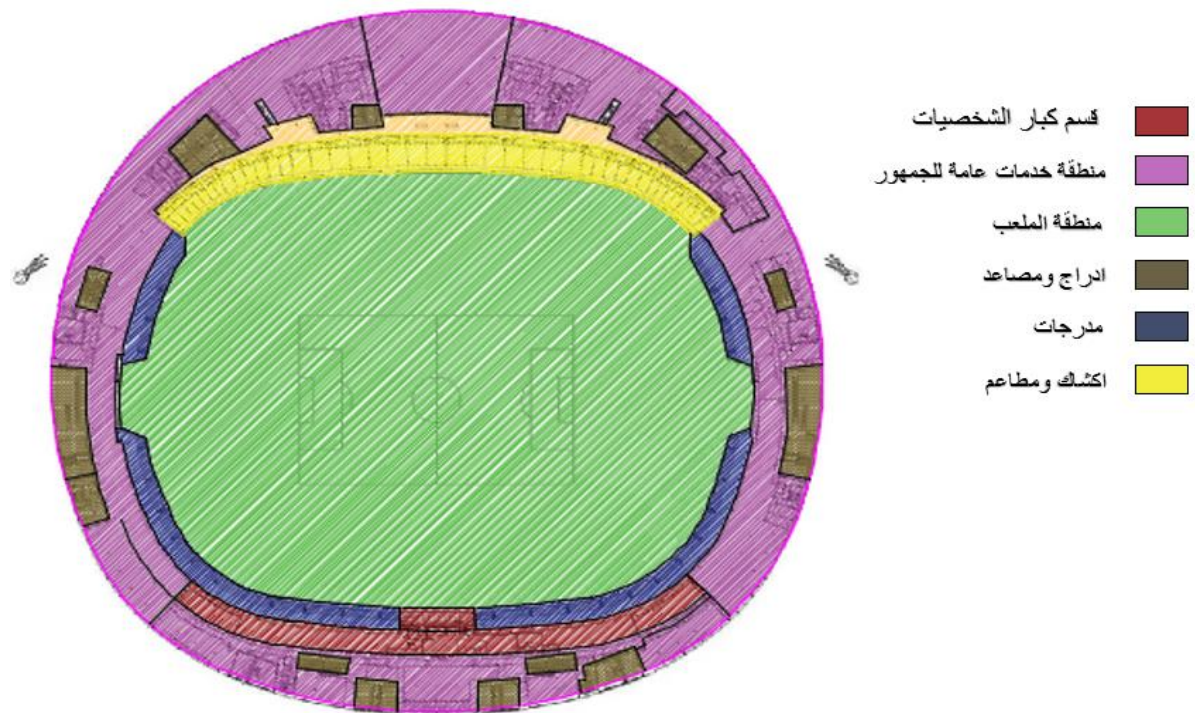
مسقط الطابق الأول (الباحث بتصريف عن <https://divisare.com/projects/16676-foster-partners-wembley-stadium>)
